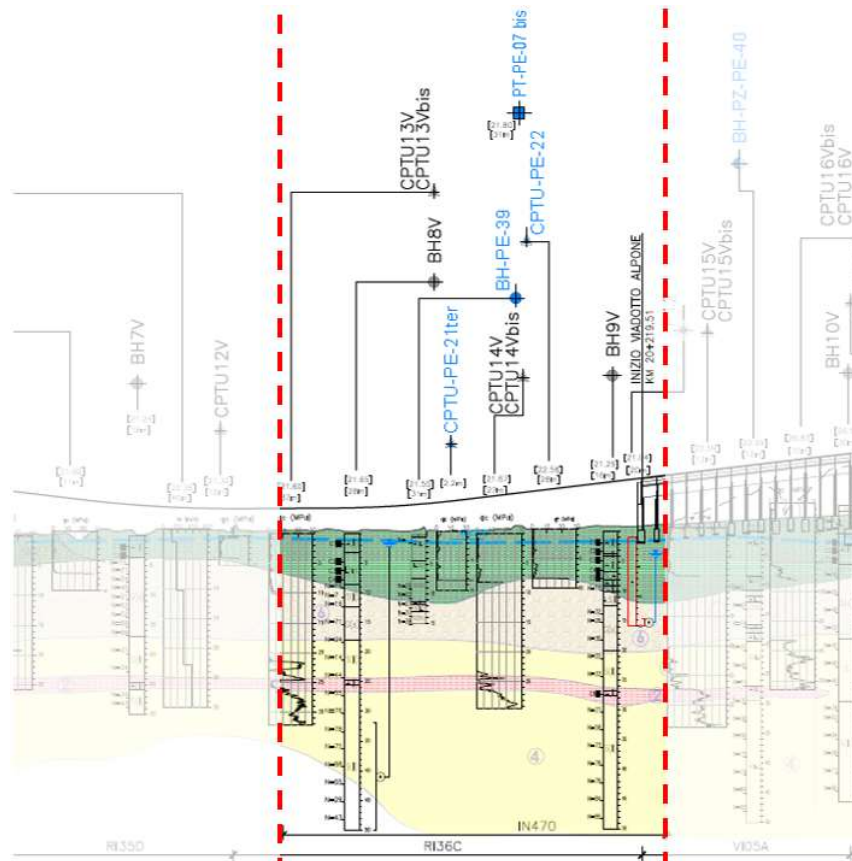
Profilo Geotecnico Rilevato RI36C, estratto dal Profilo Geotecnico Generale (Doc. Rif. [7])
